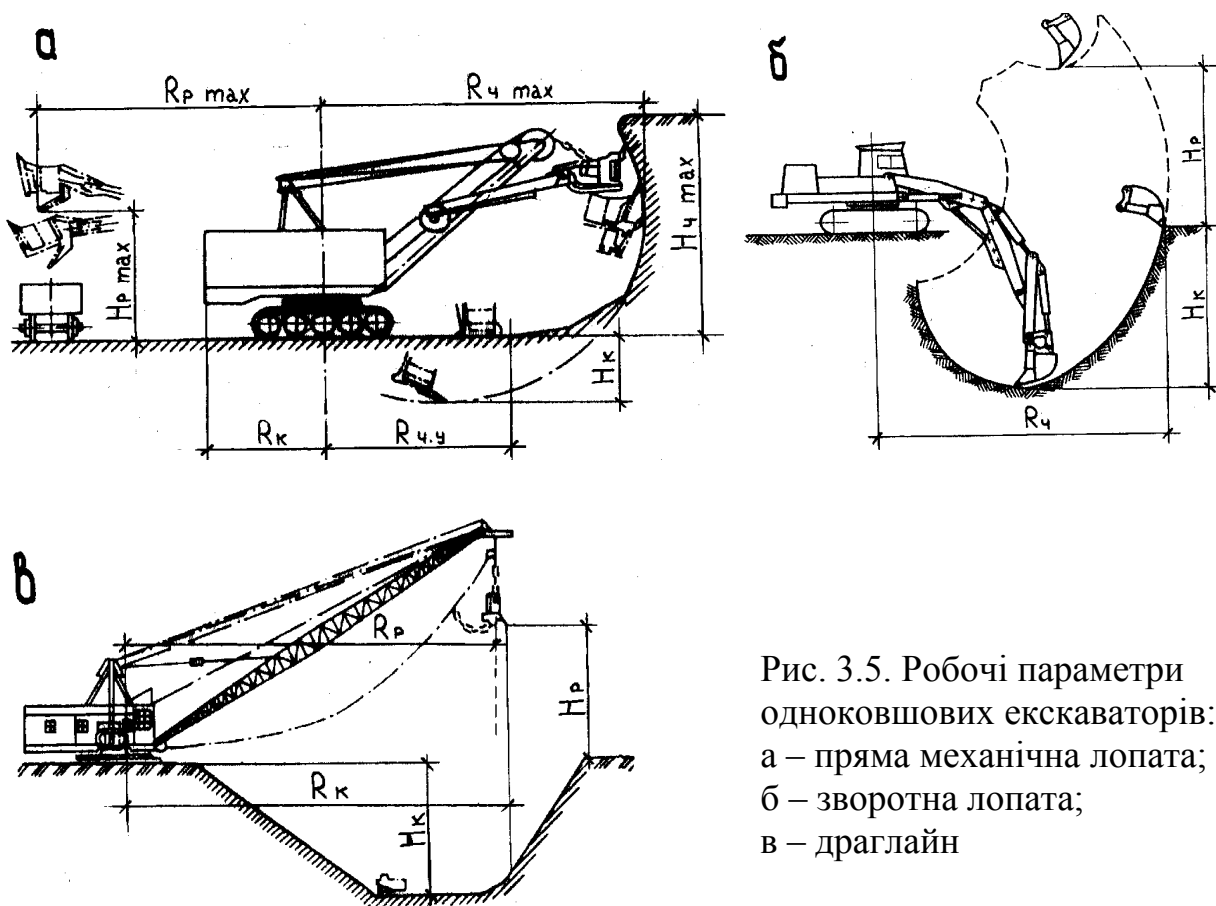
Робочі параметри одноковшових екскаваторів: а – пряма механічна лопата; б – зворотна лопата; в – драглайн
